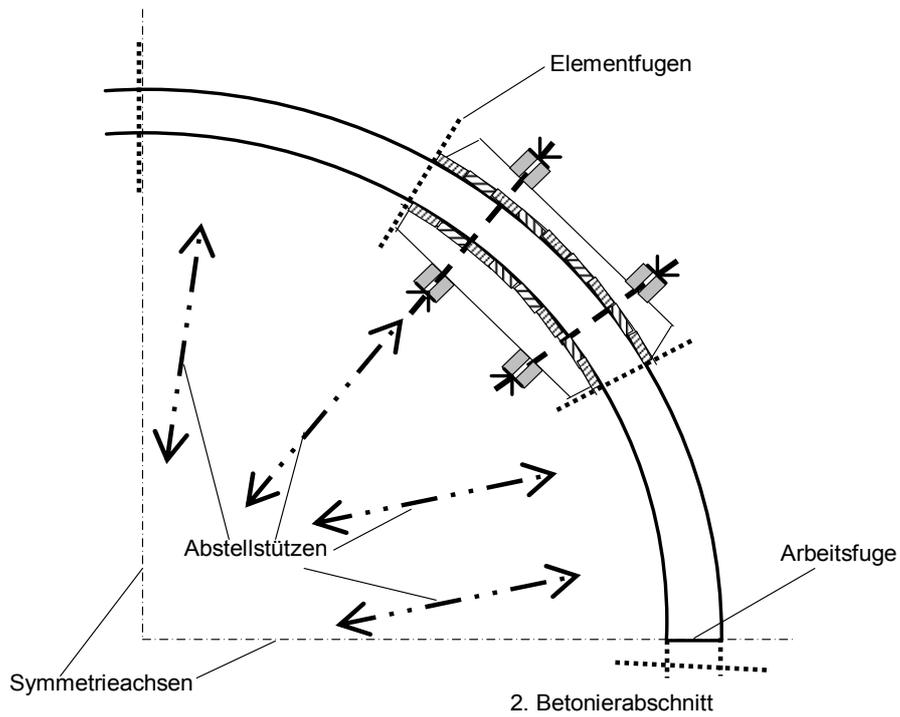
Teilgrundriss B: 1. Betonierabschnitt
